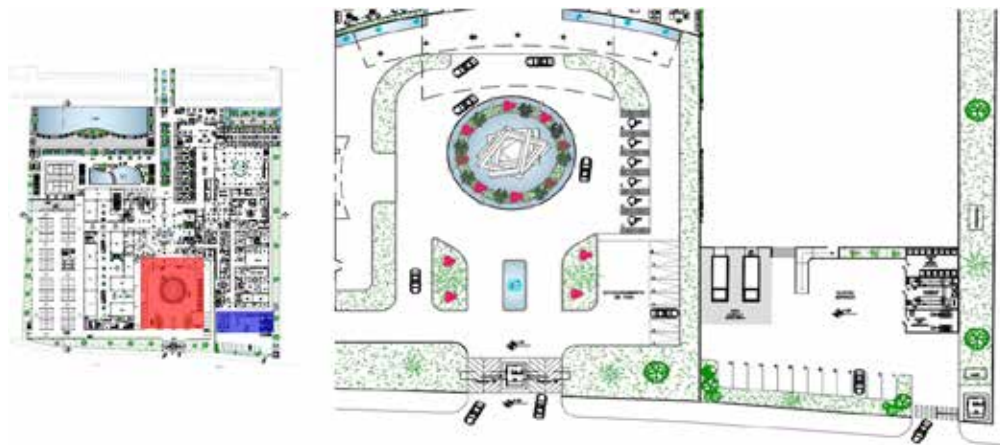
Planta baja (acceso público y de servicio). (2017)
